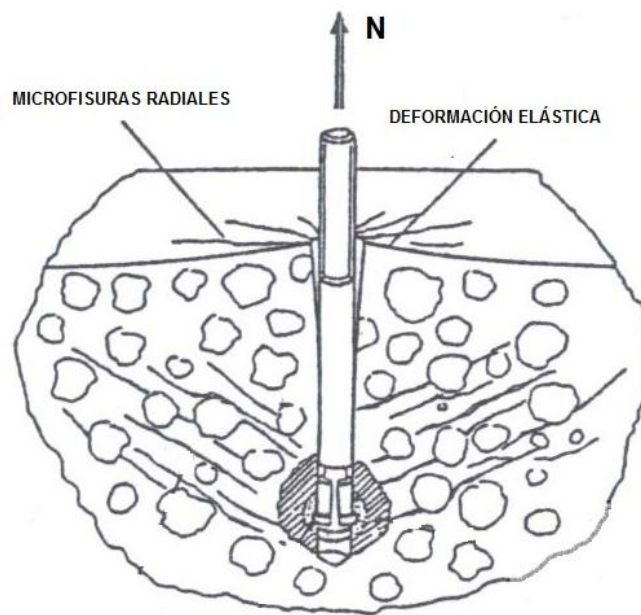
Imagen de un Sistema de Anclaje postinstalado en un concreto fisurado.
